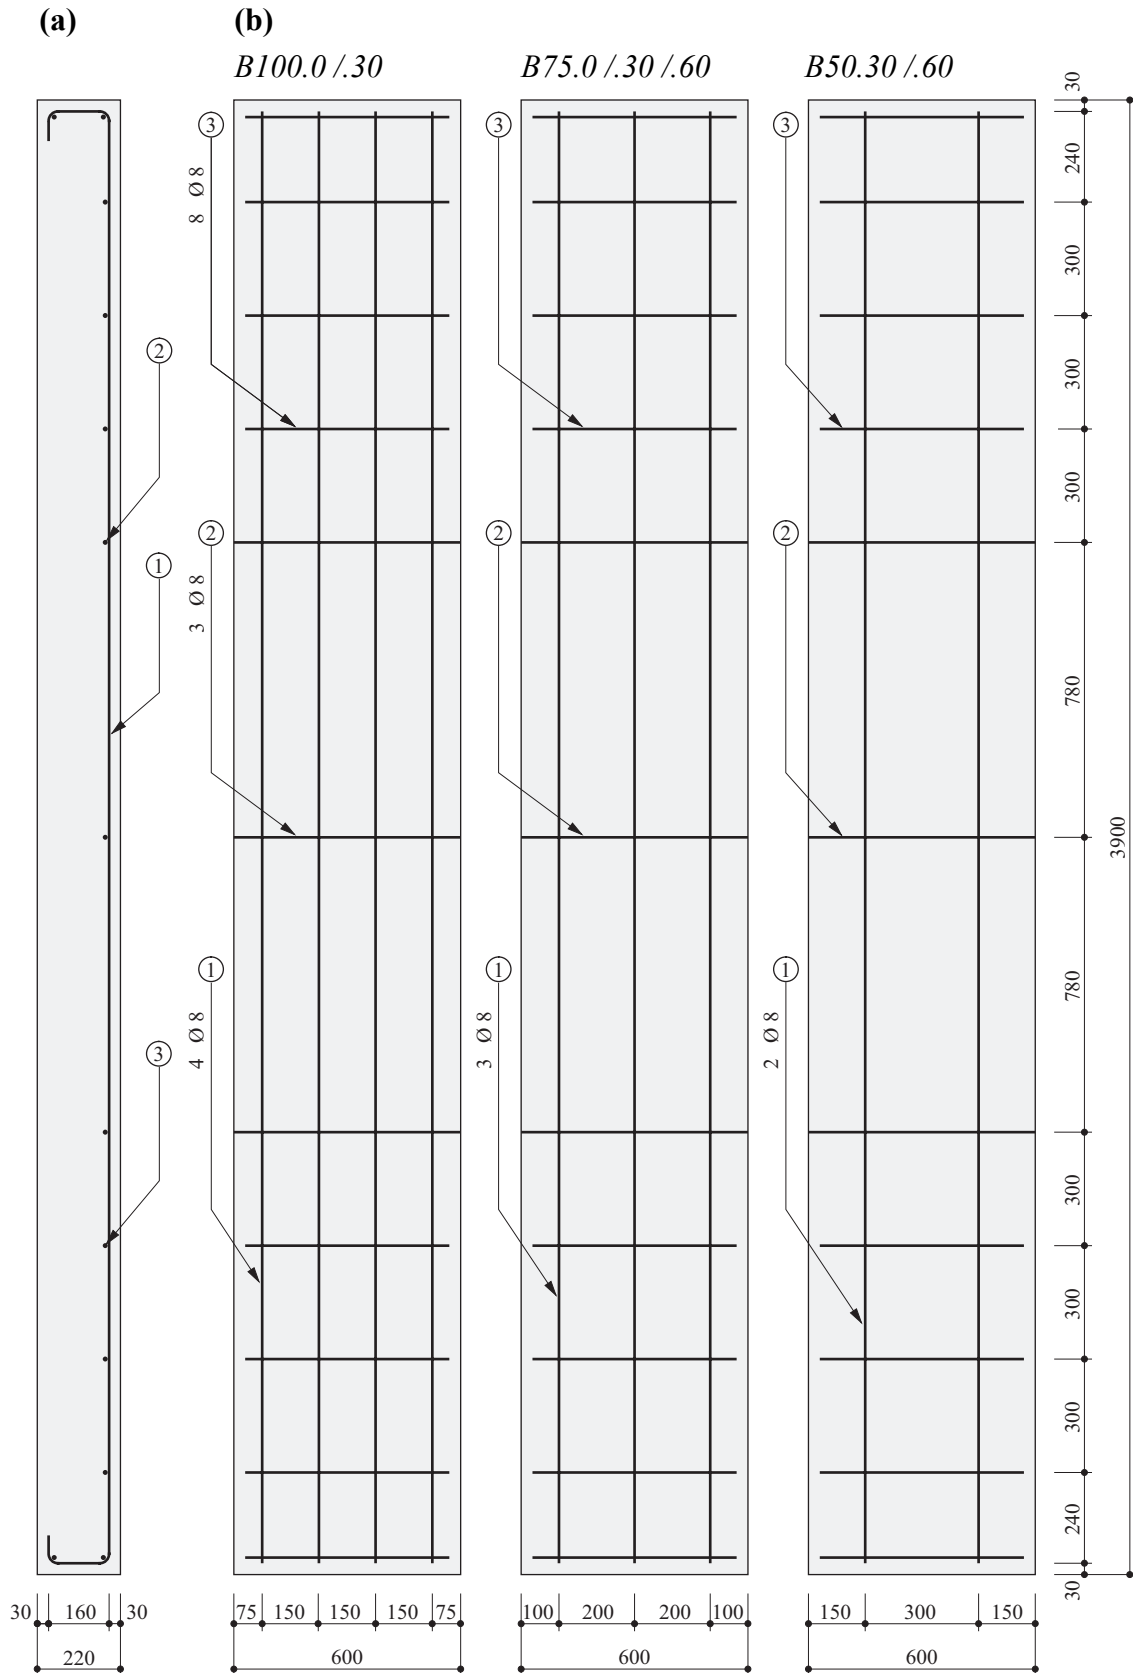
Abmessungen und Bewehrung der schlaff bewehrten Biegeversuchskörper:
